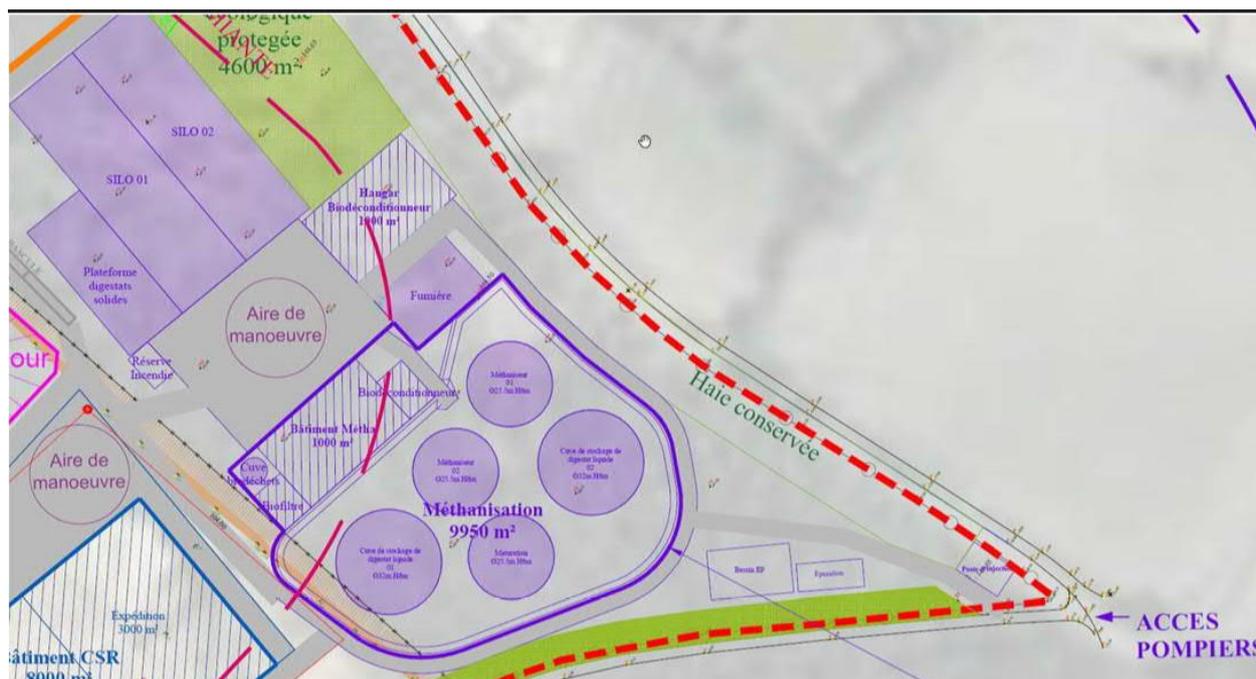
Extrait du plan de masse de l'installation et positionnement envisagé du poste d'injection
